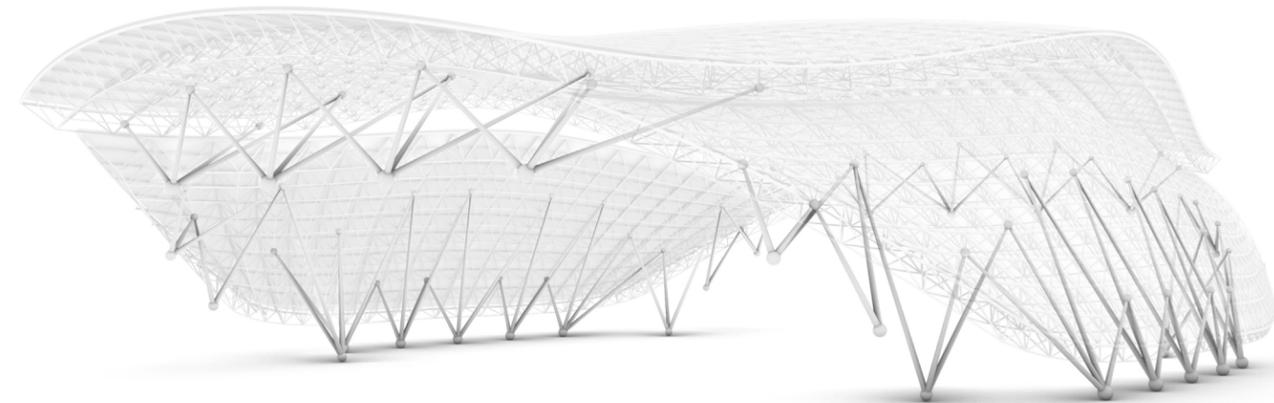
Estructura de soporte de la cubierta. Elaboración propia.
